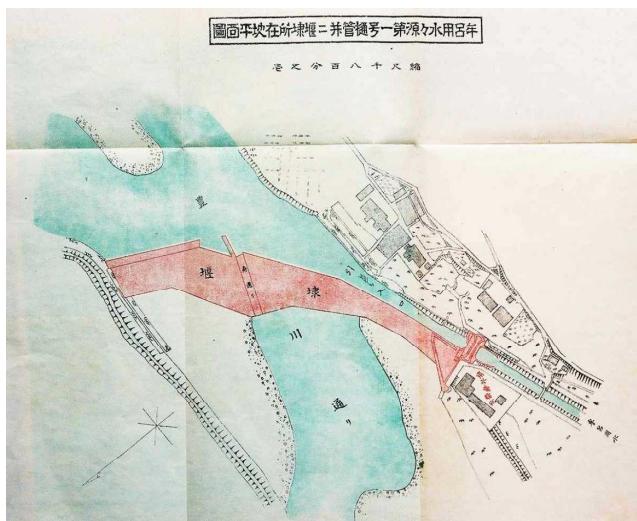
牟呂用水水源堰堤と第1号樋管の平面図
